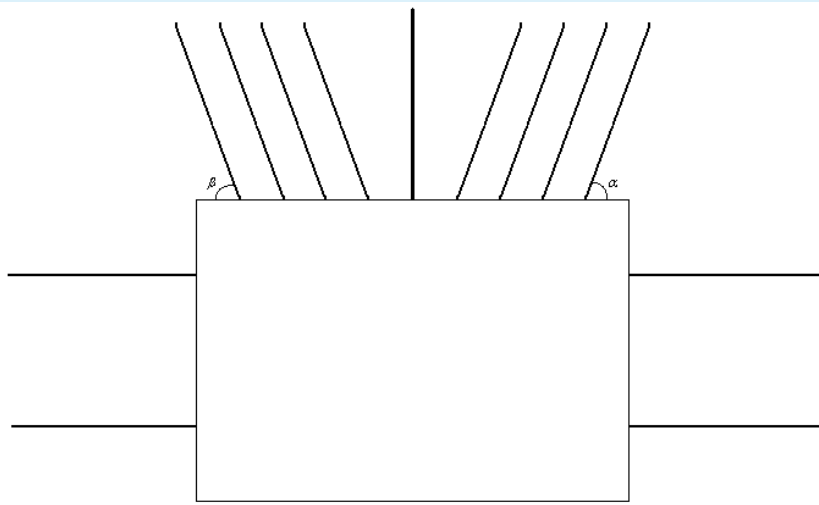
Расчетная схема исследования влияния угла наклона анкера на НДС массива горных пород в выработке с прямоугольной формой поперечного сечения
